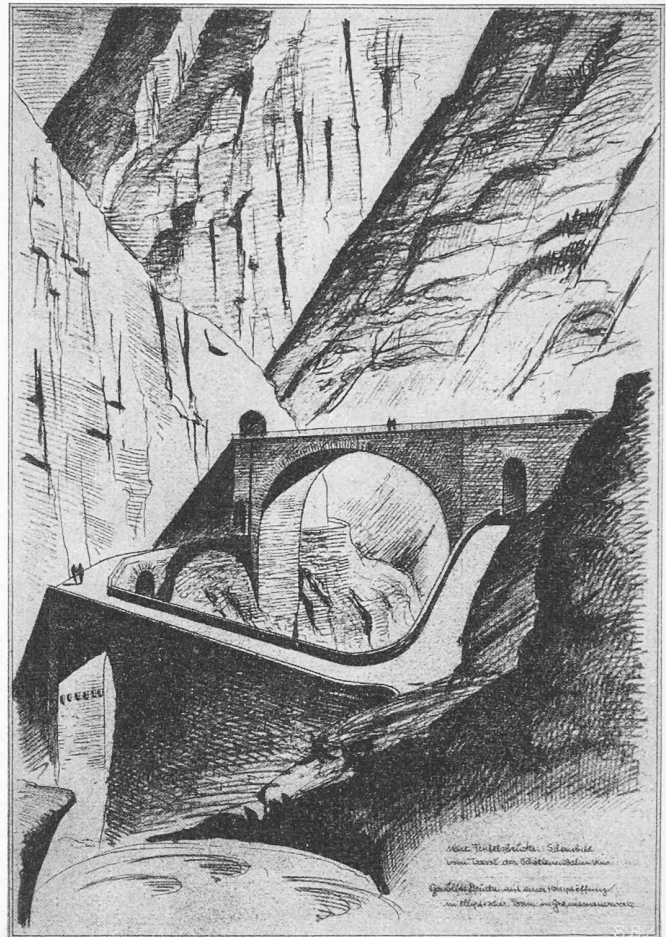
Gewölbte Brücke in Granitmauerwerk, mit einer Hauptöffnung
